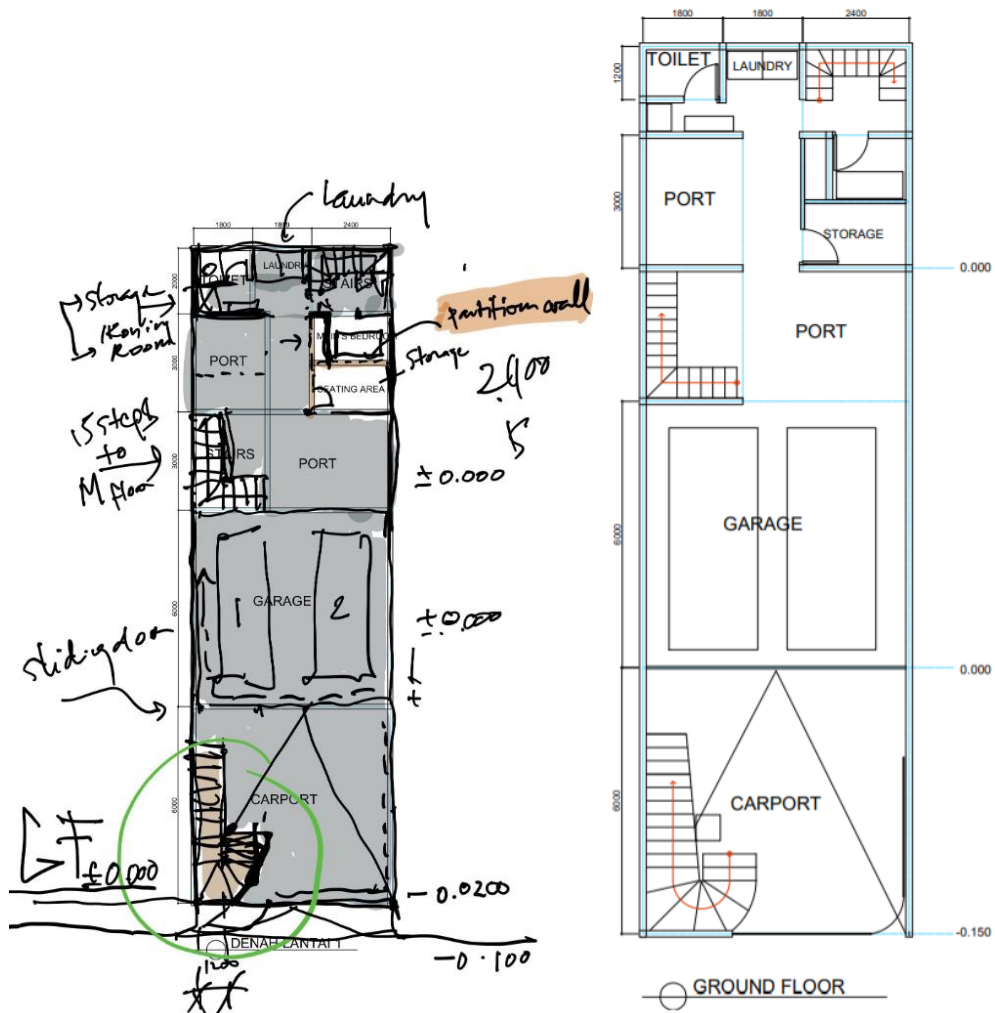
4a dan 3.4b Denah Lantai 1 dan Lantai 2a
